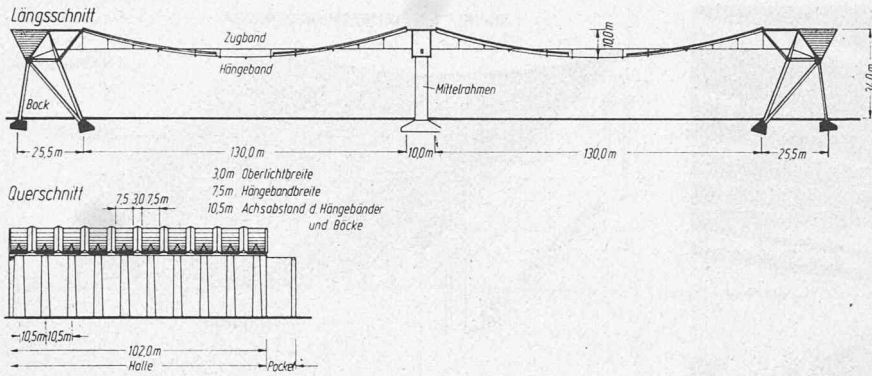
Wartungshalle V, Frankfurt, Längs- und Querschnitt
